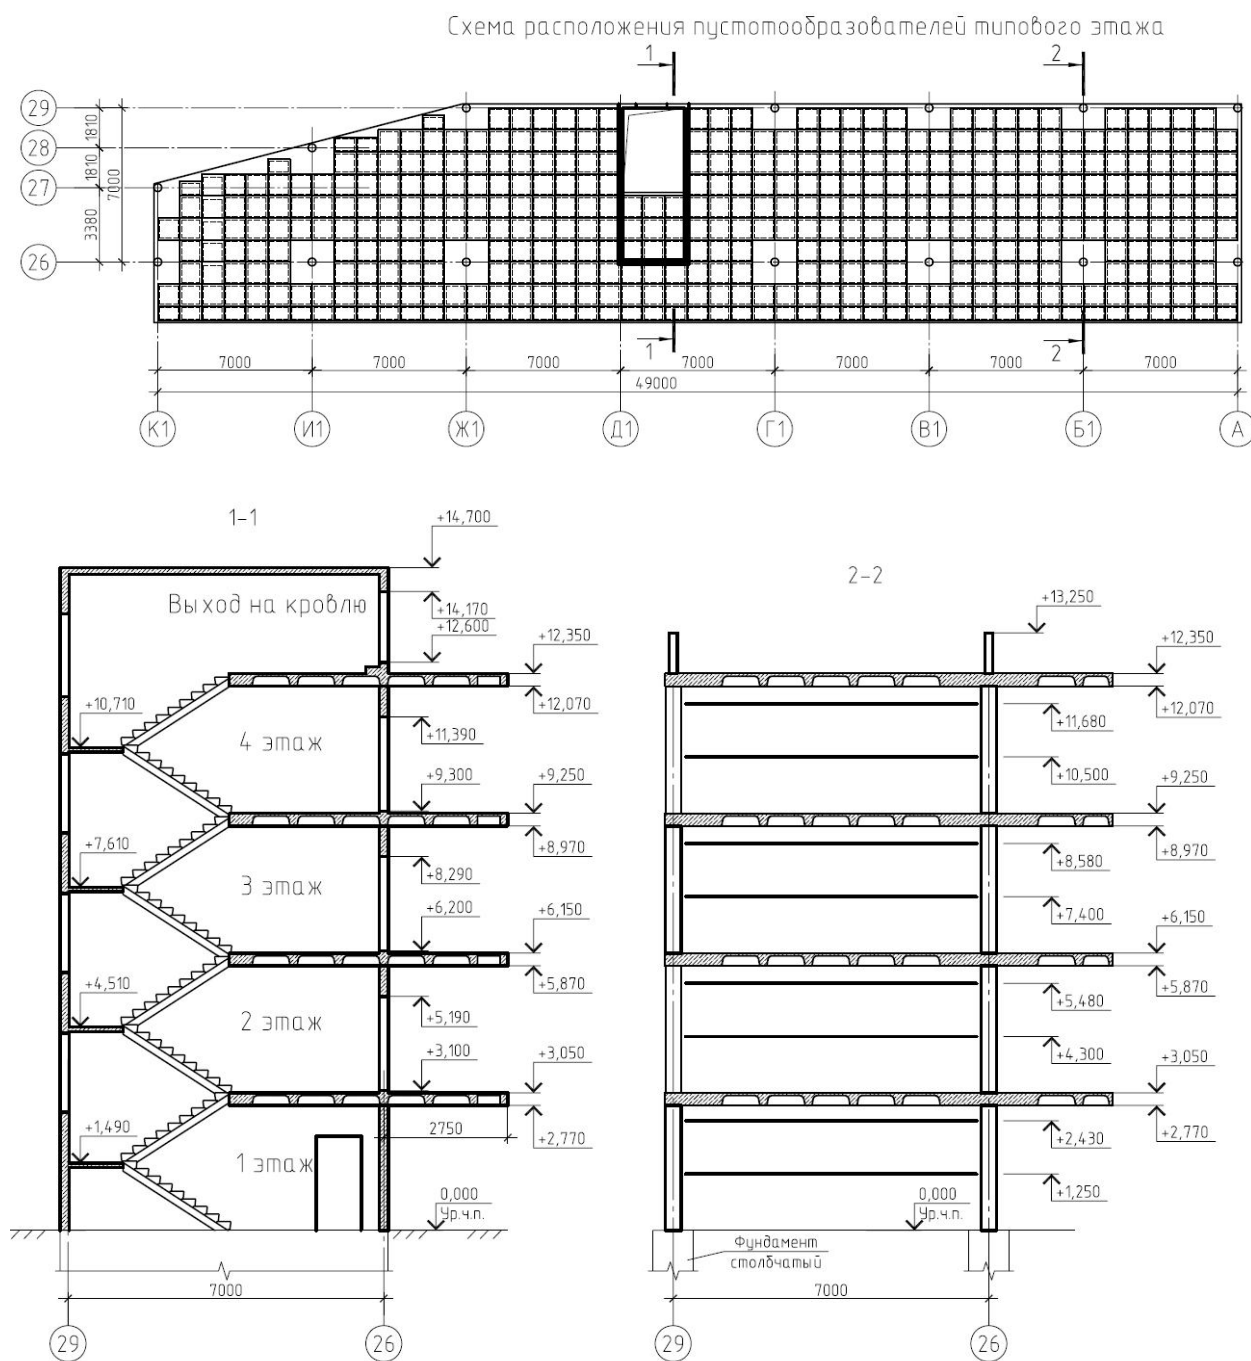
Монолитный каркас с кессонными перекрытиями.
